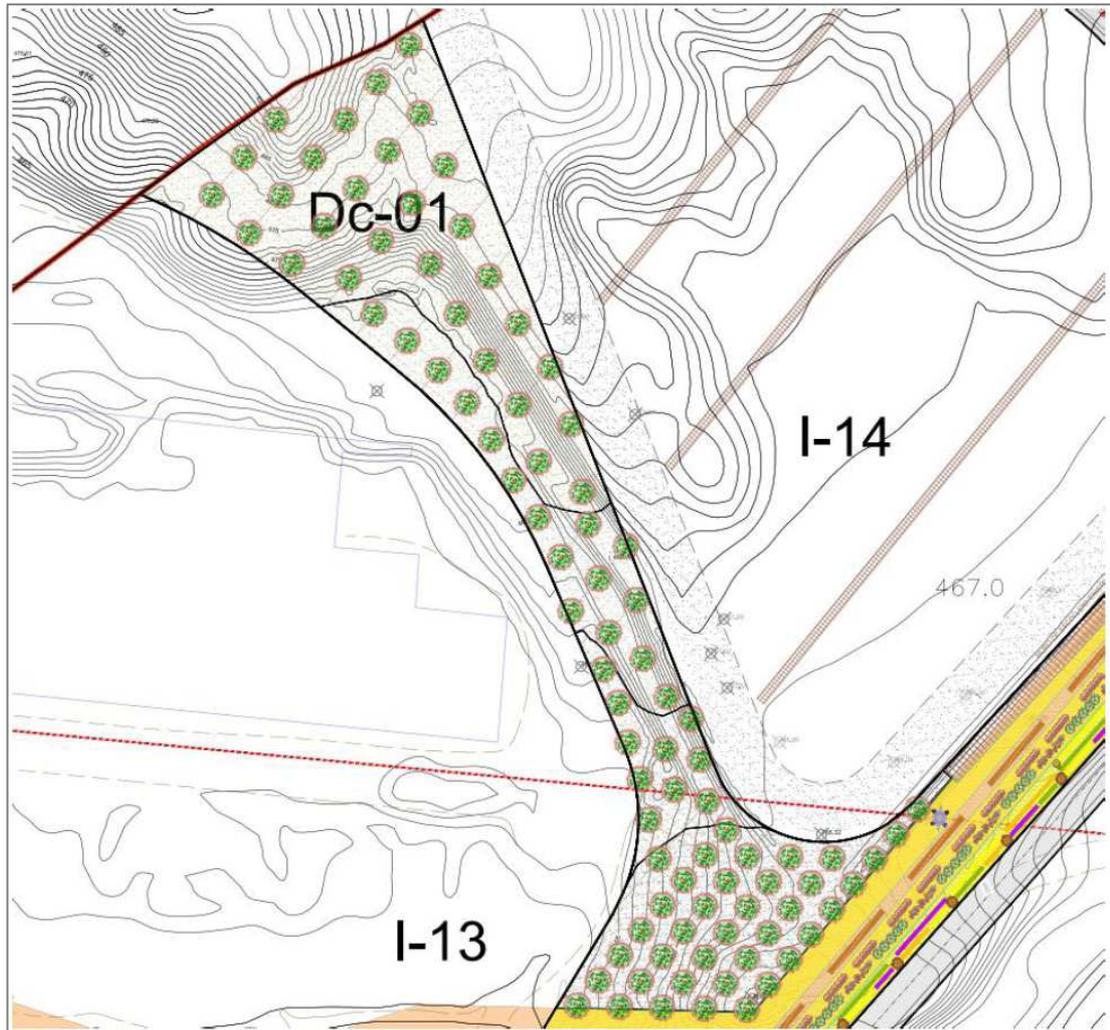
Proyecto en el ámbito de la DC-01 REFORESTACIÓN.
